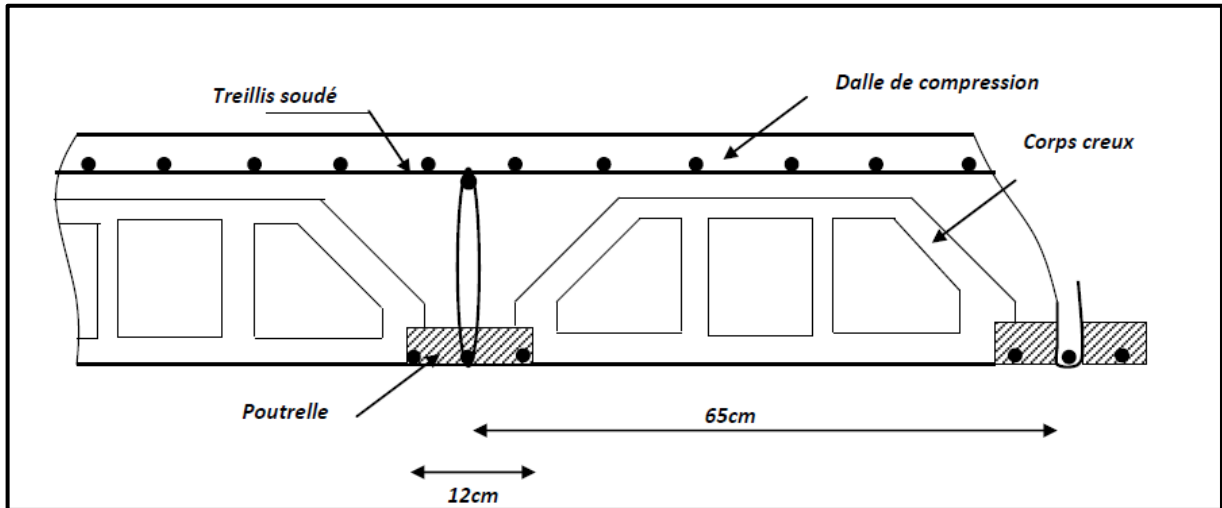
Coupe transversale d'un plancher en corps creux (16+4)
